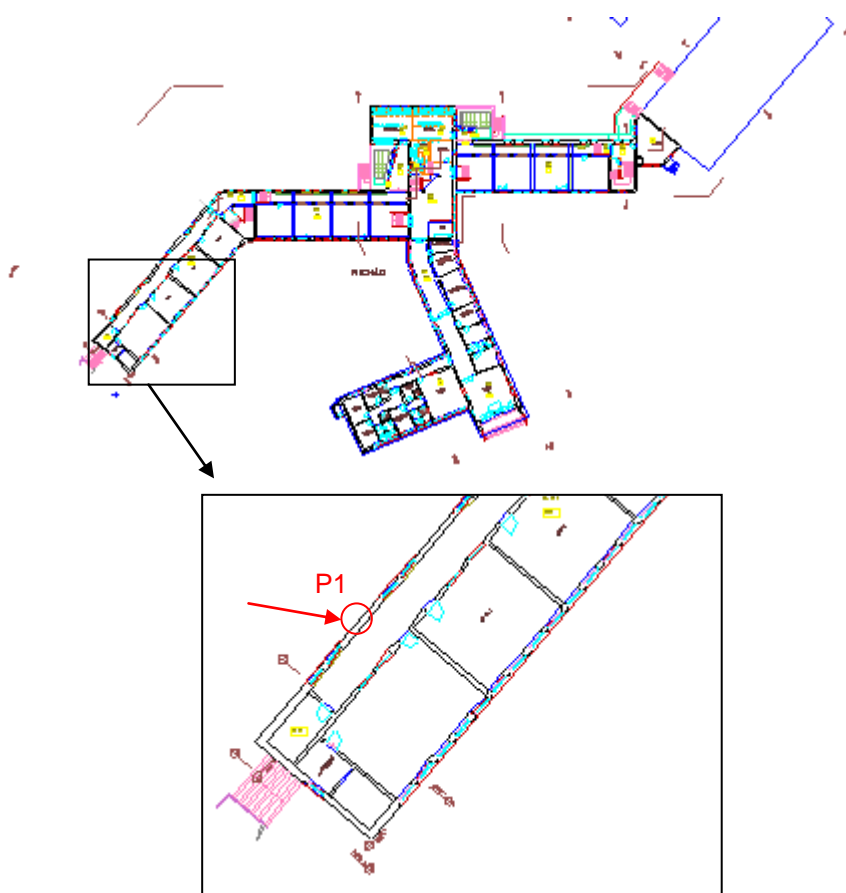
Planta da escola e pormenor do local em que se realizou o ensaio com macacos planos.
